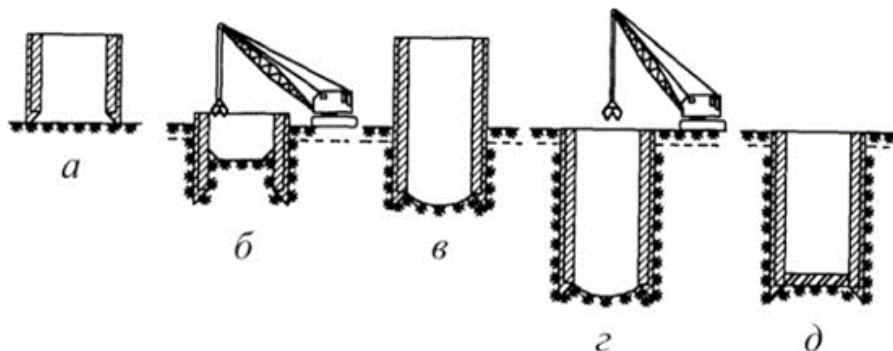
Послідовність влаштування опускного колодязя:
